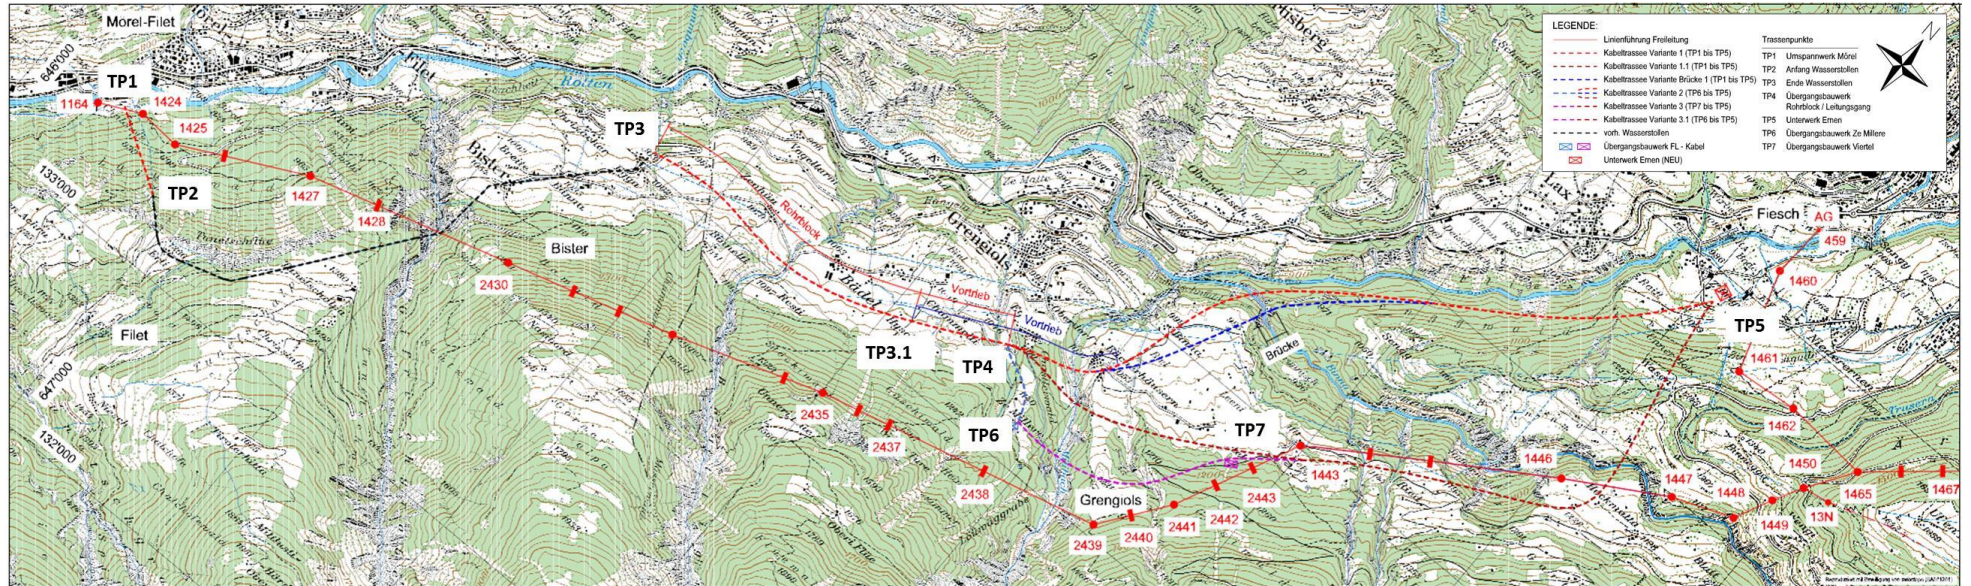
Lageplan mit untersuchten Trassenvarianten
